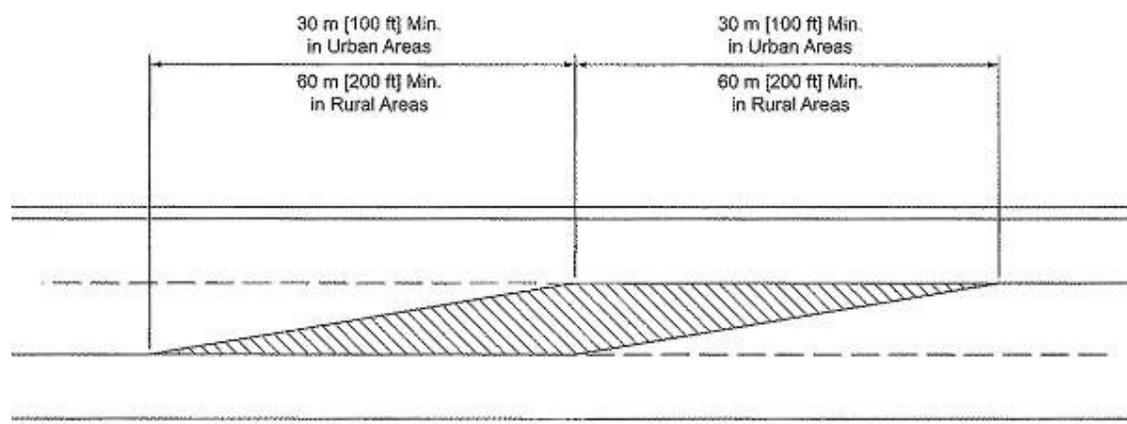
Esquema de abocinamientos para adición de carril en una calzada 2+1
